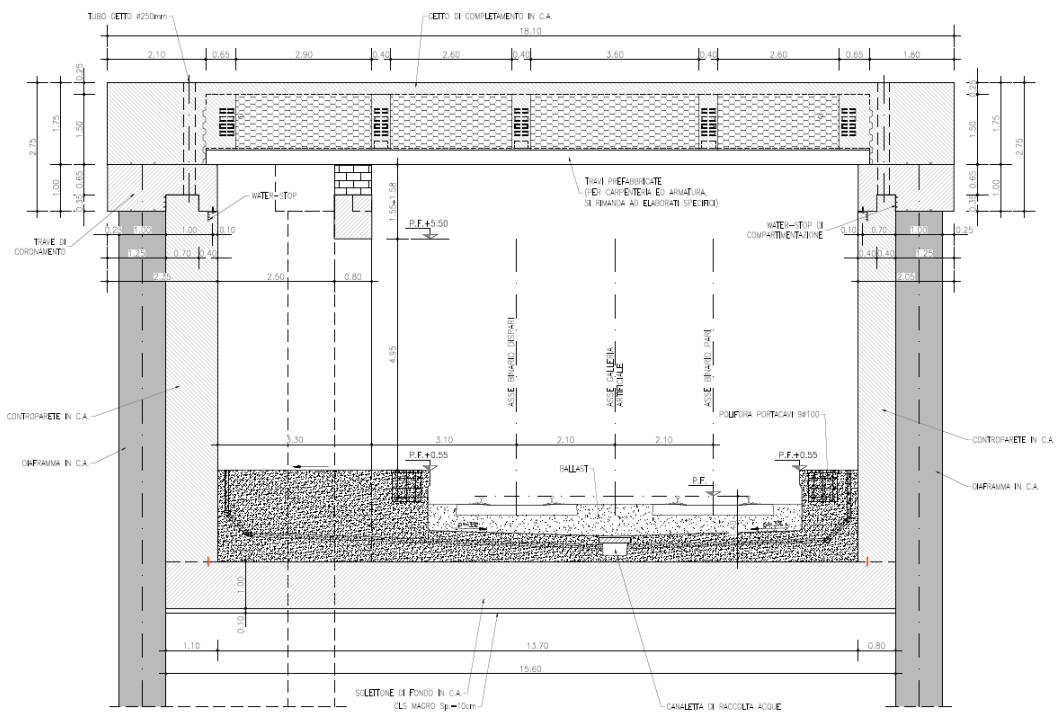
Sezione trasversale tipica in corrispondenza della nicchia
